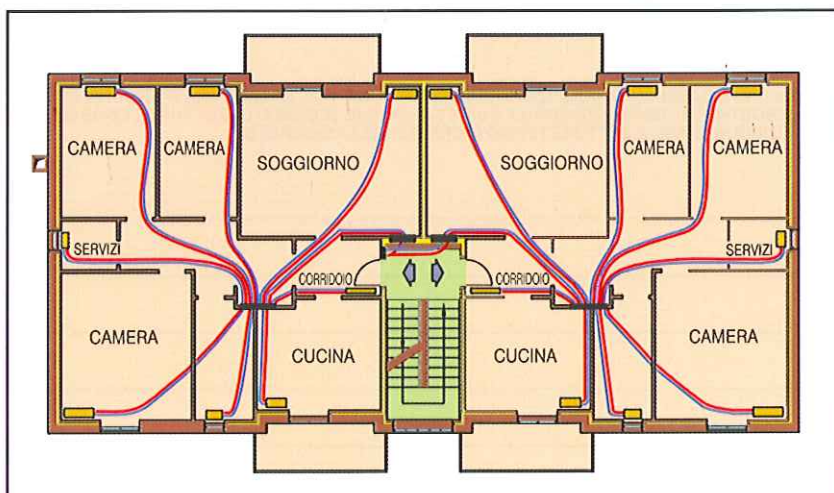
Planimetria con distribuzione orizzontale.
